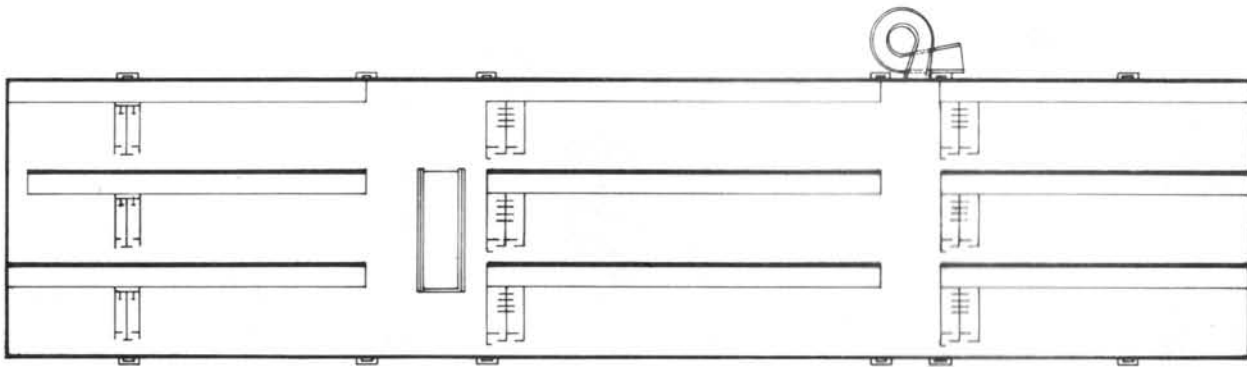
PLANTA BAIXA ORIGINAL EDIFÍCIO CASTELLO BRANCO
